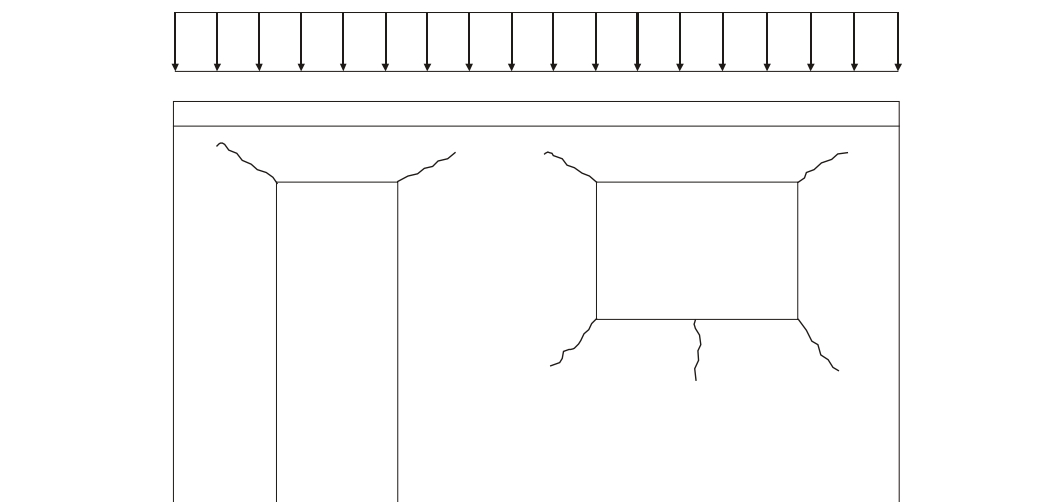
Configuração típica de fissuras em paredes com aberturas de portas e janelas, submetidas a carga uniformemente distribuída e com inexistência ou deficiências de vergas e contravergas.
